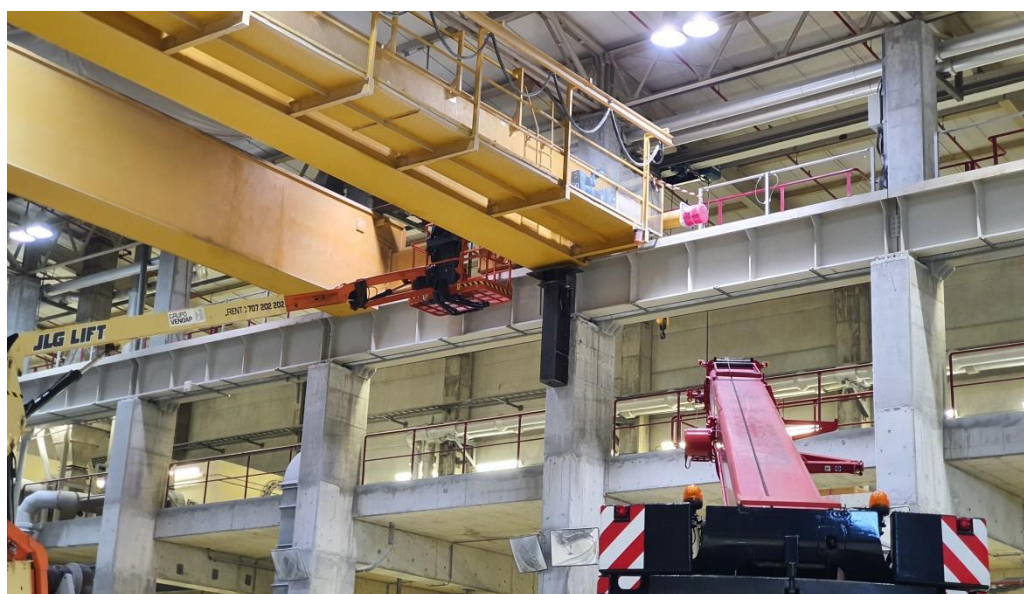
Remoção do carro da ponte rolante da zona seca.
